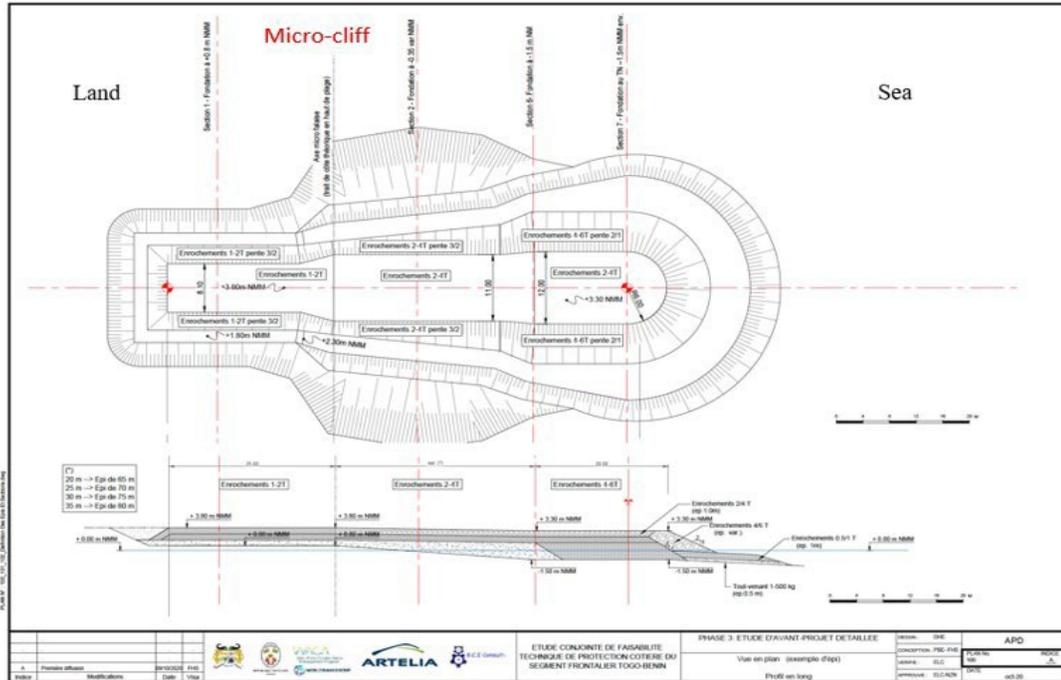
Vue en plan et en coupe d'un épi<sup>134</sup>
